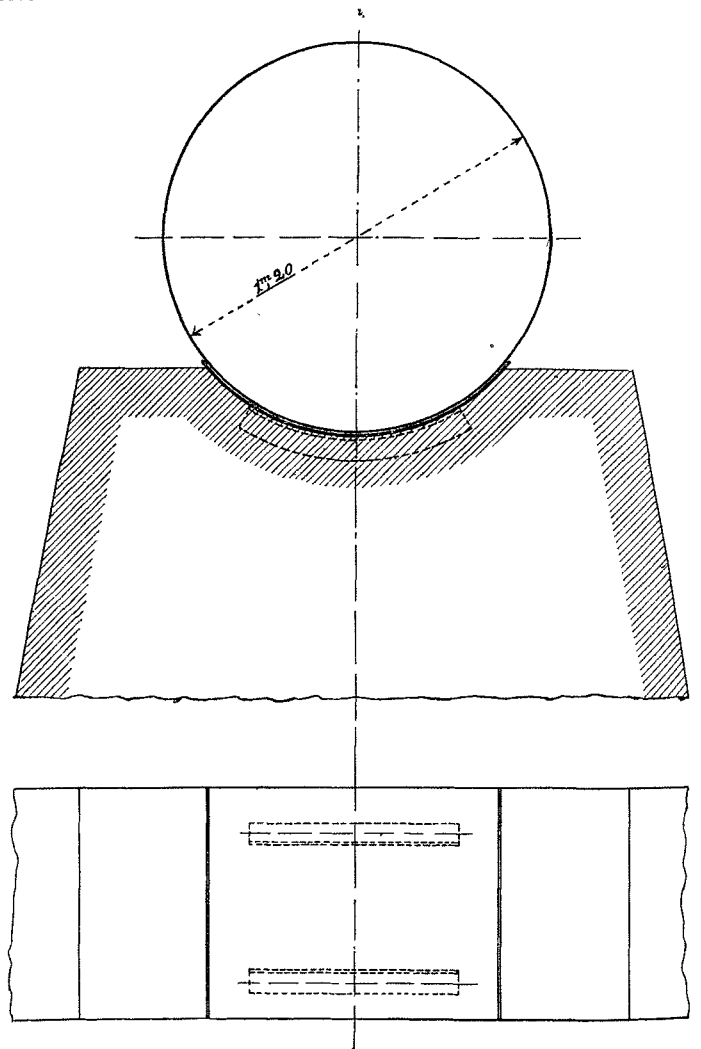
PLAN ET COUPE VERTICALE D'UN PILIER SUPPORTANT LA CONDUITE FORCÉE
